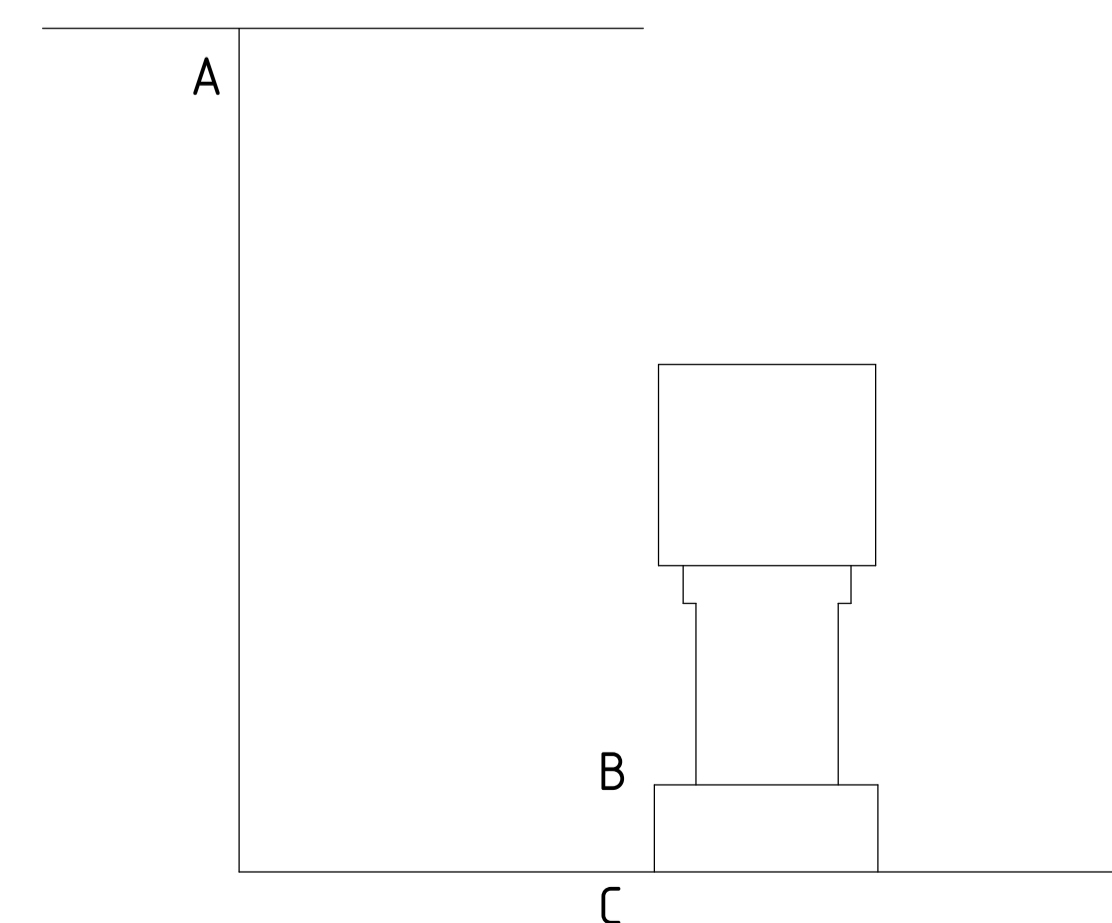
Detail B aansluiting pompwatergebouw -3,0m N.A.P.
